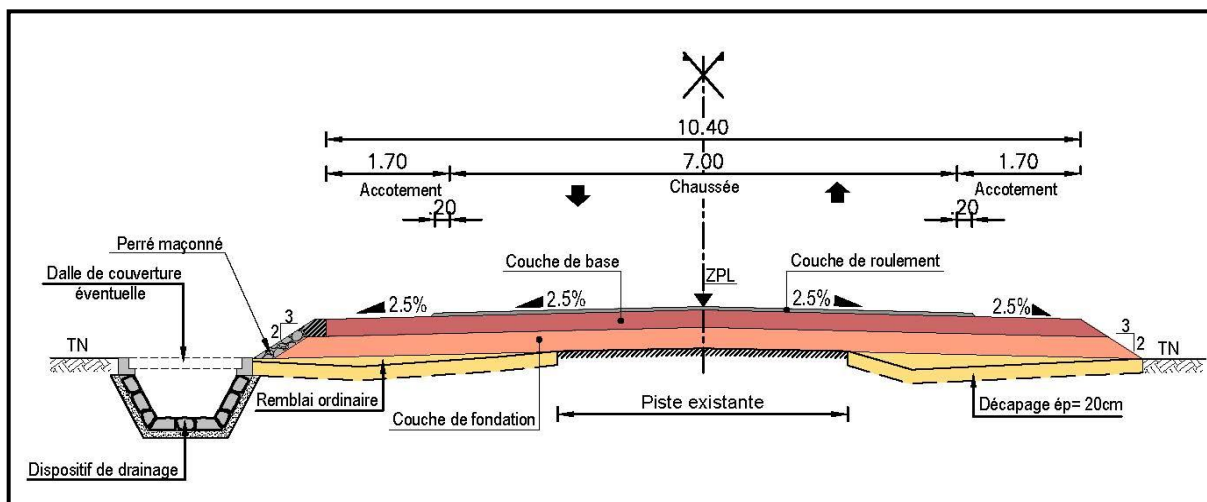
PROFIL EN TRAVERS TYPE 2
